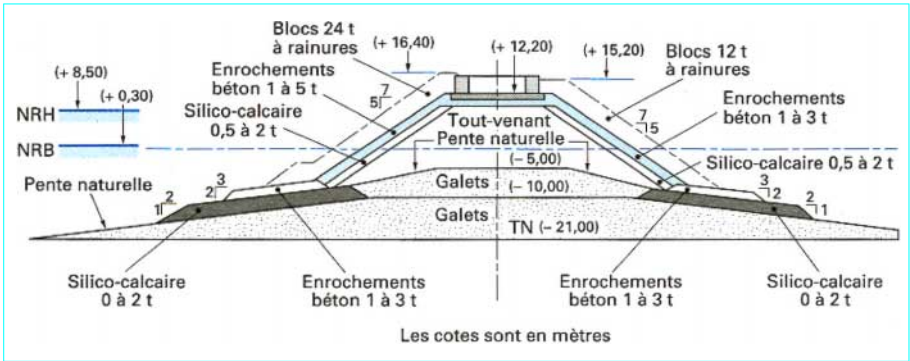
Port du Havre-Antifer : coupe type de la digue
